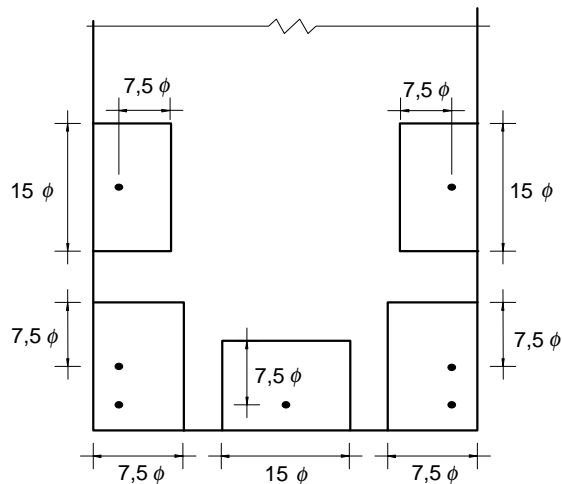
Critérios para determinação das áreas para verificação da fissuração.
